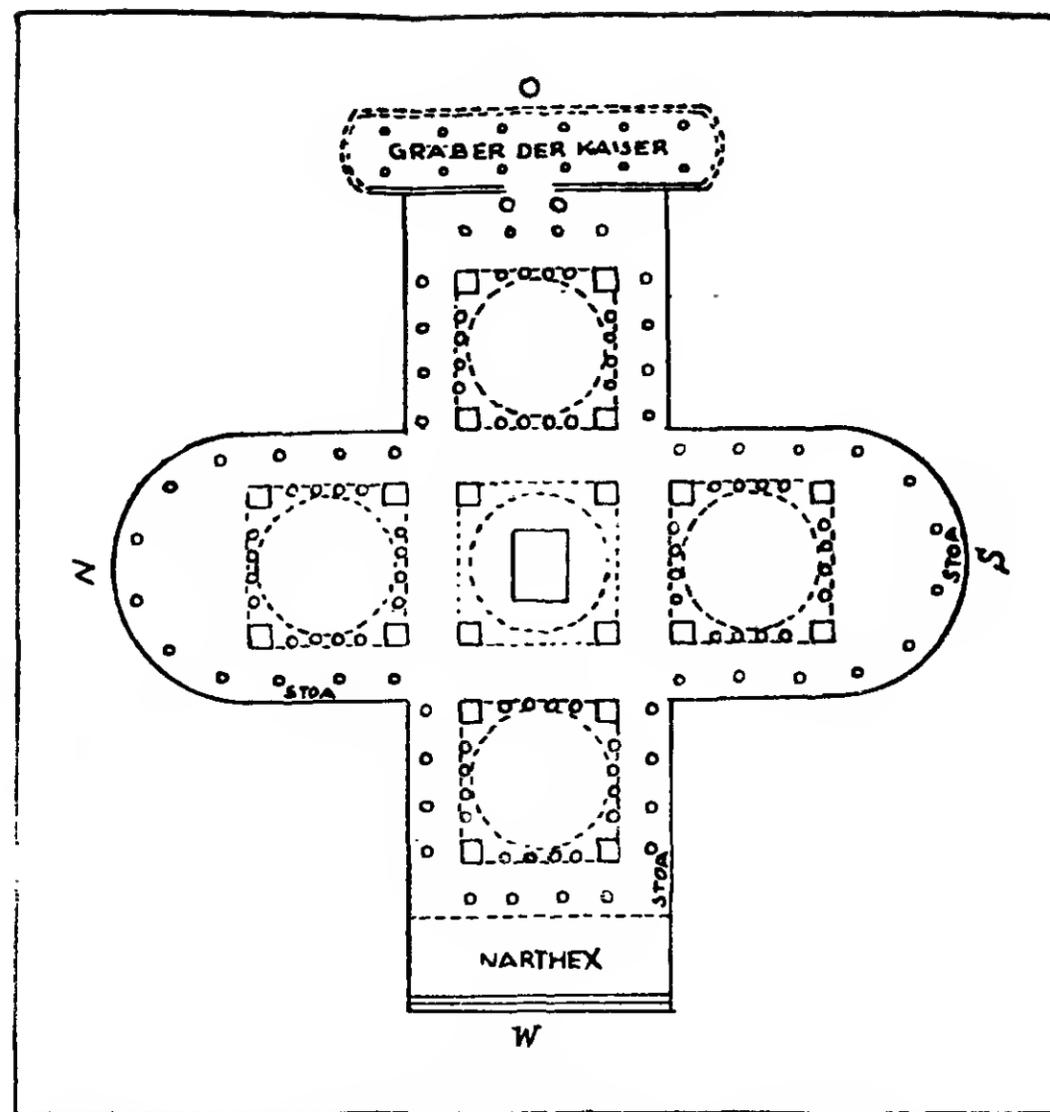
DIE APOSTELKIRCHE, REKONSTRUIERTER GRUNDRISS VON TH. REINACH 1896.
